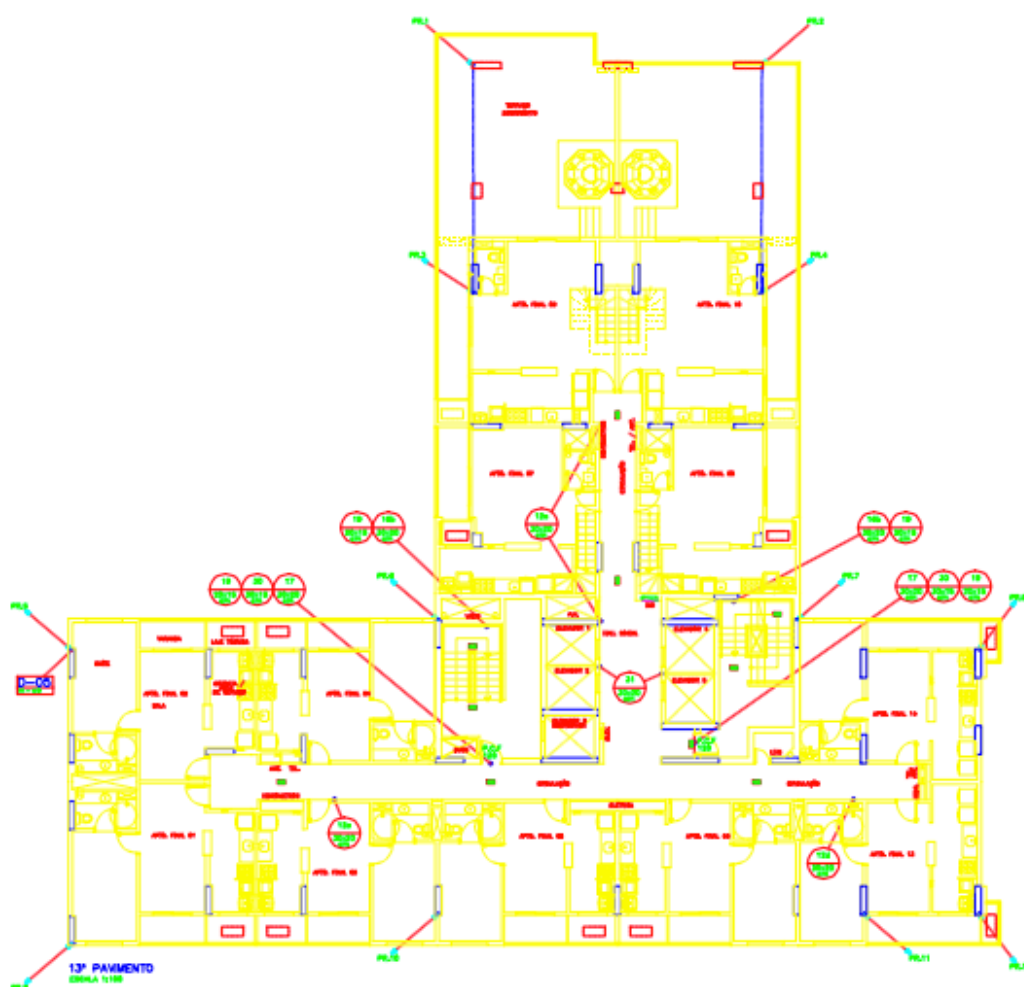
Projeto de SPDA original para o 13º pavimento, com terraço descoberto.
